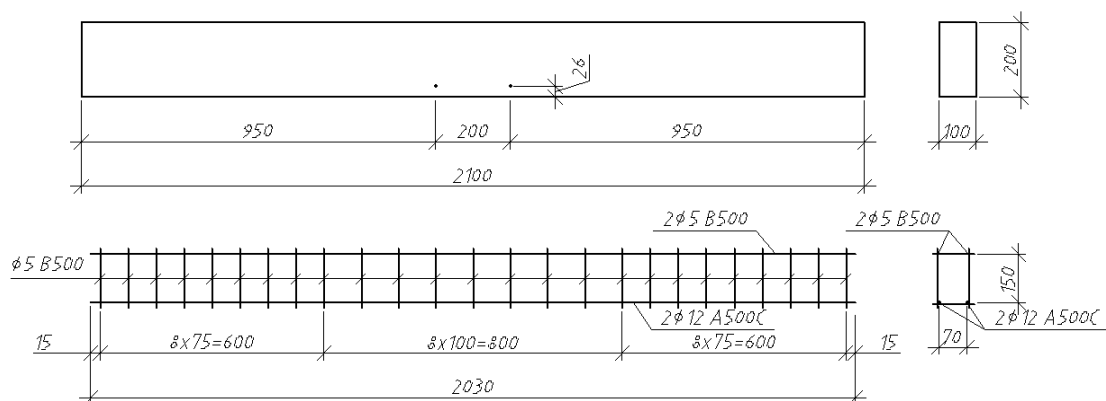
Опалубне креслення експериментальних балок та конструкція арматурного каркаса
